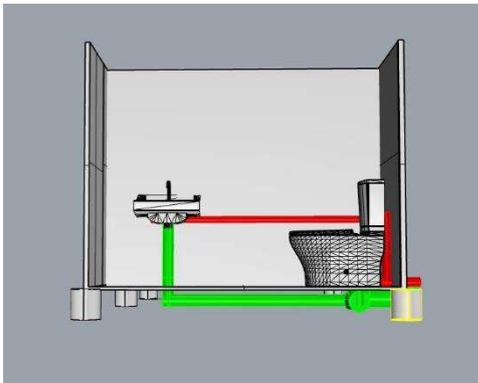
Esquema de instalação hidráulica (Fonte: Autor 2021)
